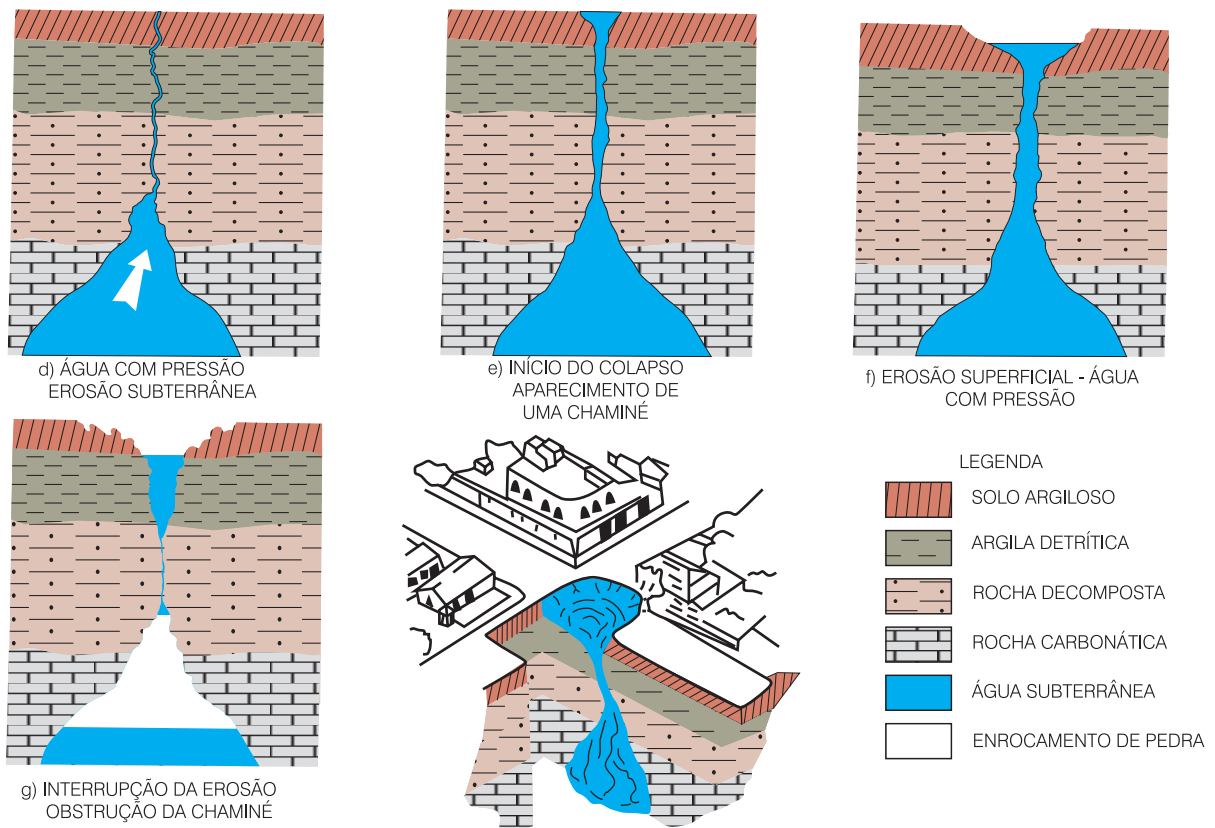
Esquema do colapso em Sete Lagoas / MG, (modificado de Silva, 1988).
